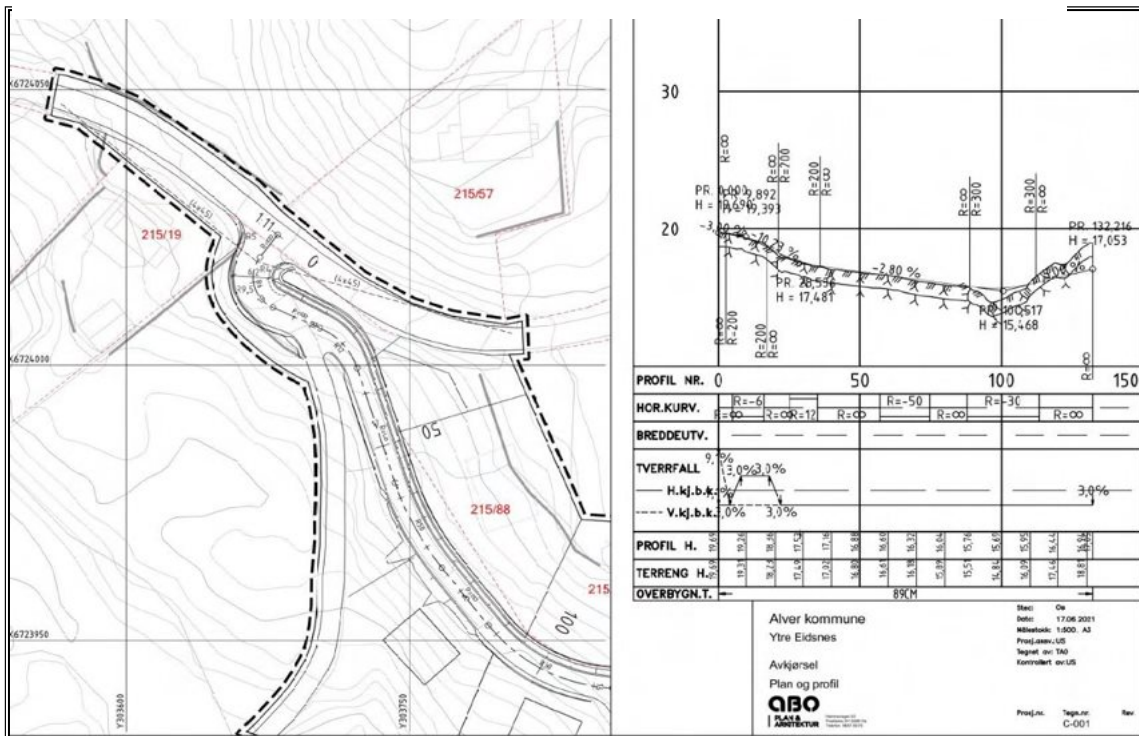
Utsnitt av plankart som syner avkøyrsl til planområdet.
